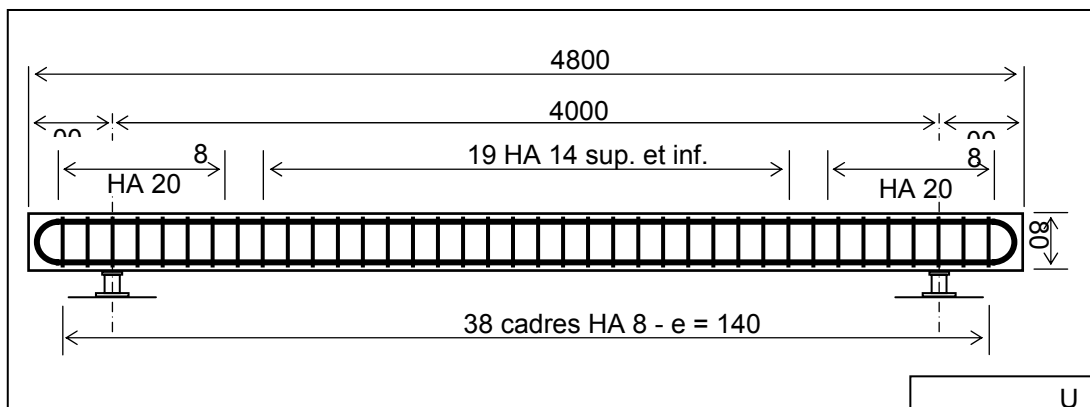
coupe dans le sens transversal de la dalle d'essai
